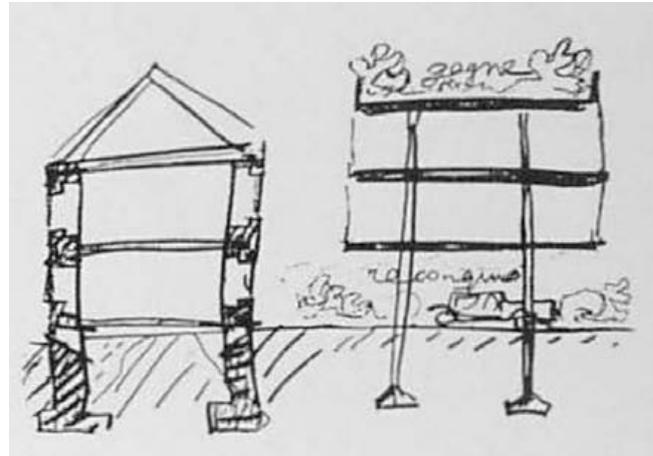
Esquema comparativos de la construcción con muros de carga y la estructura reticular de hormigón armado, 1930, Le Corbusier. Grinda Efrén, (1996). Tectónica 3 – Hormigón (I) “In situ”, pág. 9, Madrid, España, ATC Ediciones.
